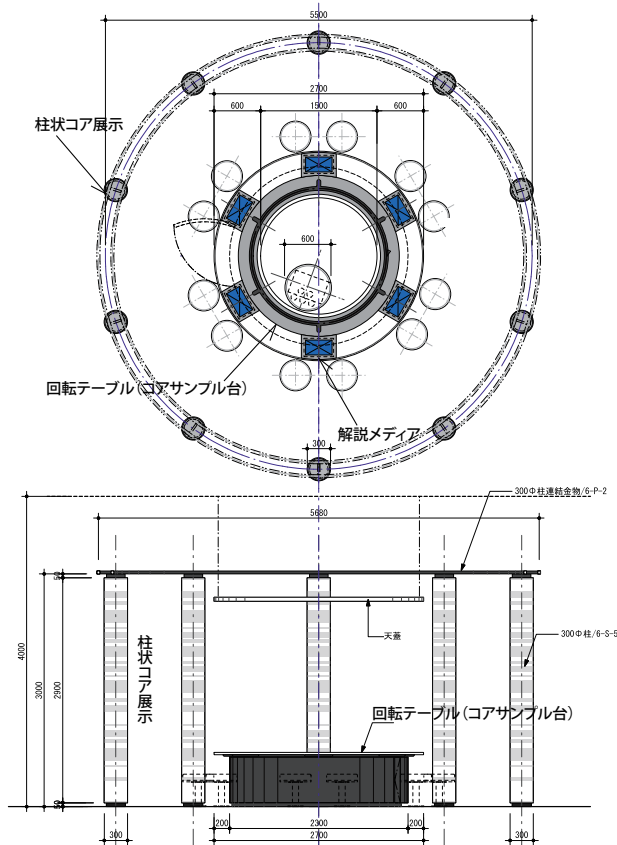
ボーリングコアステーションの平面図(上)と立面図(下)
